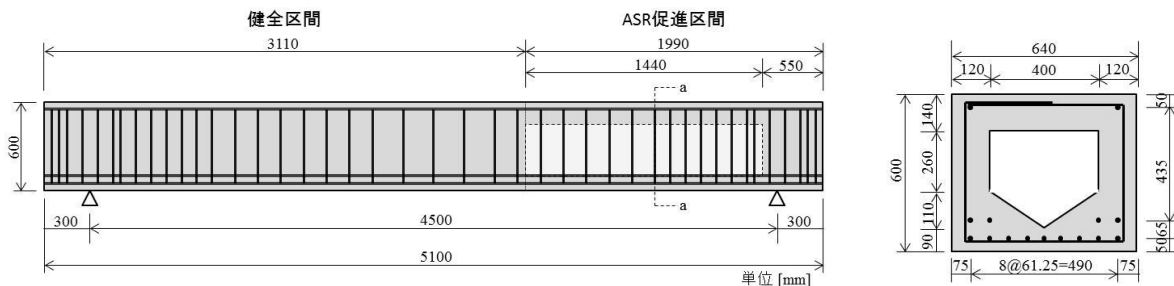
試験体寸法（左：側面図，右：a-a 断面図）
